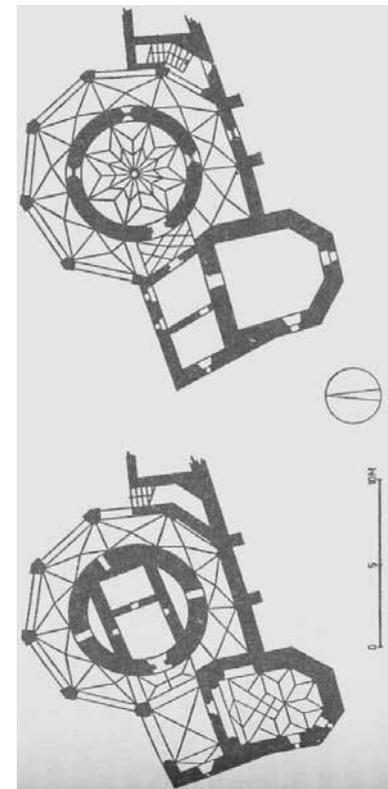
Grundriss des Karners in Maria Saal
